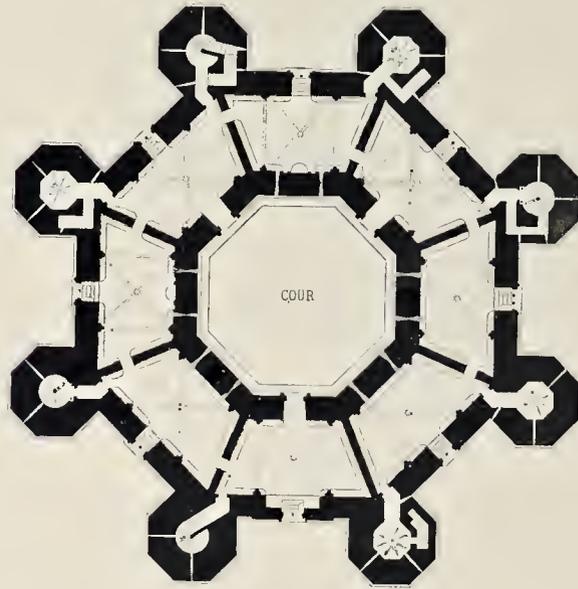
CASTEL DEL MONTE. PLAN DU PREMIER ÉTAGE.
